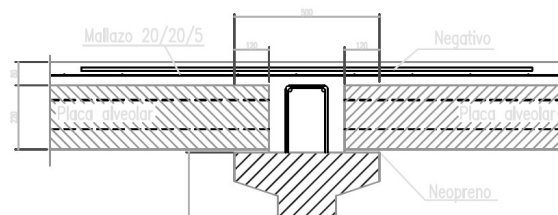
Detalles de capa de compresión y apoyo de placas sobre vigas
